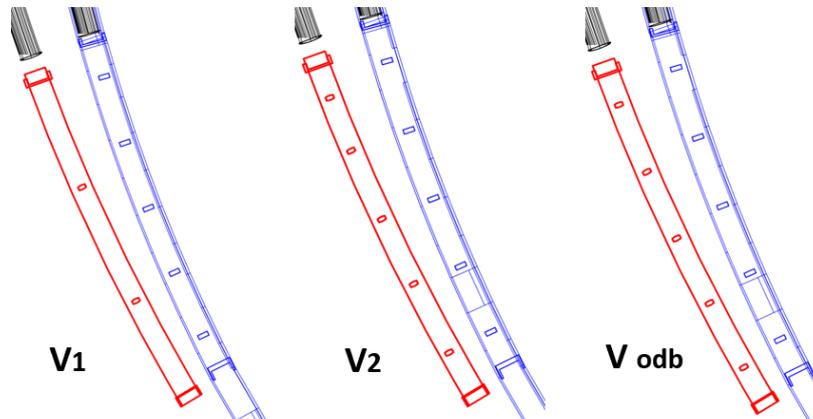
Prikaz pogleda na vijadukt Šum – varijanta 2 (plavo – postojeći, crveno – planirani)
